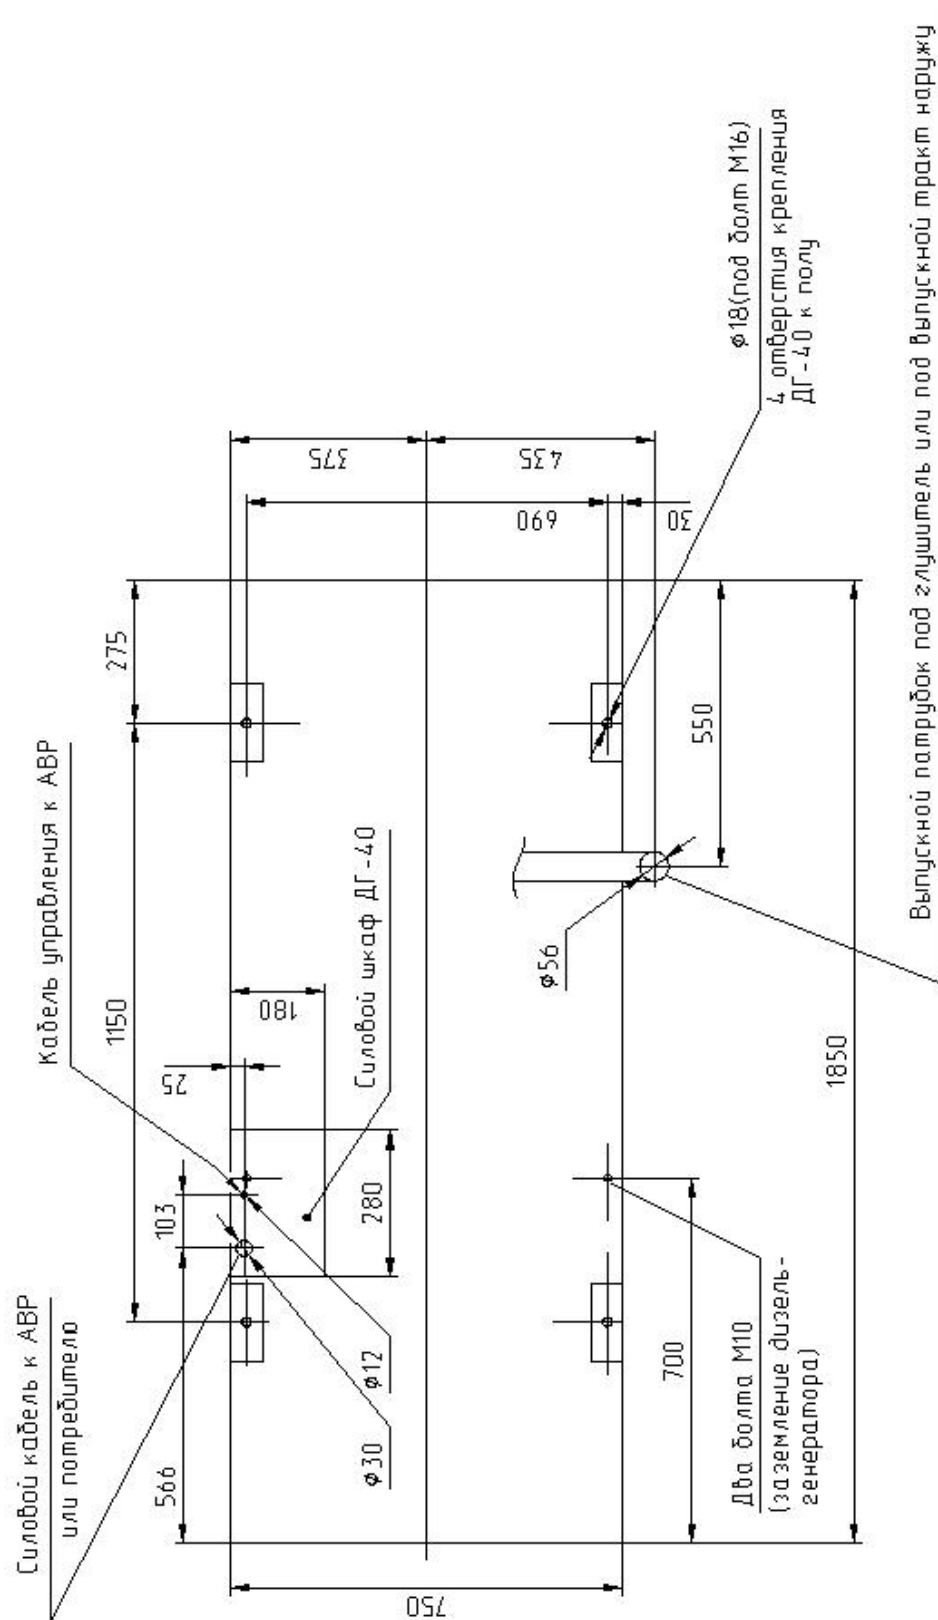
Монтажный чертеж установки ДГ-40 (вид сверху)
